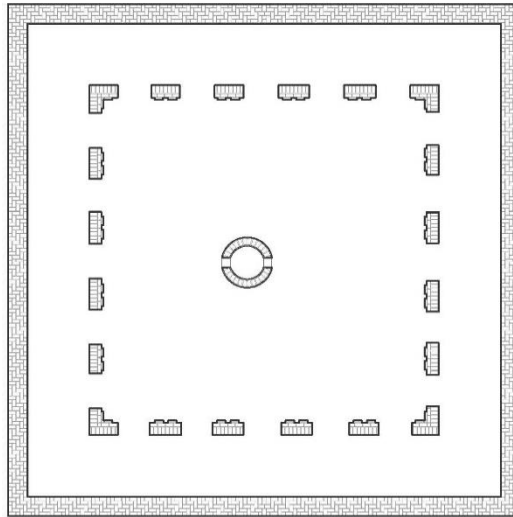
Planta común de un claustro (Alejandro Serra 2016).
